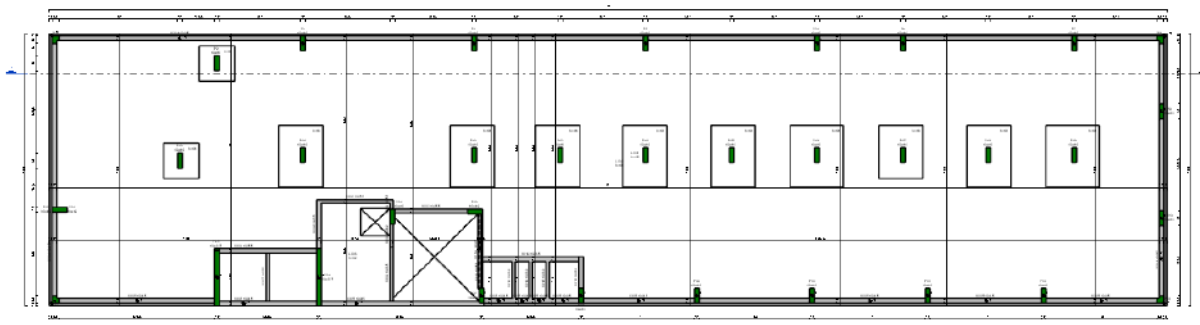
Localização das vistas das plantas de formas da superestrutura.
